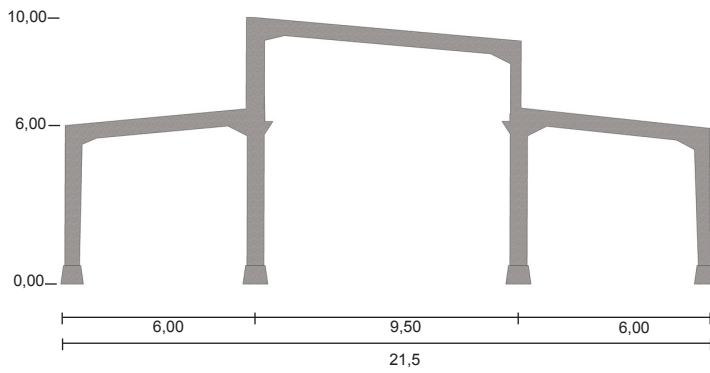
Elaboración propia a partir de planimetría original Casa de Máquinas de Temuco y medidas tomadas en terreno
